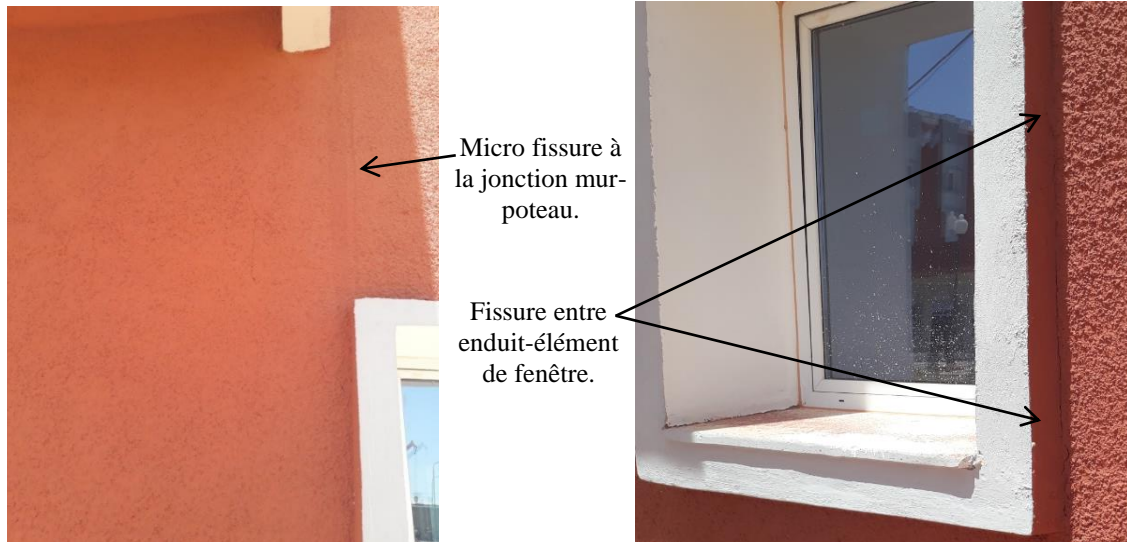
Fissure à l'interface mur-poteau.
